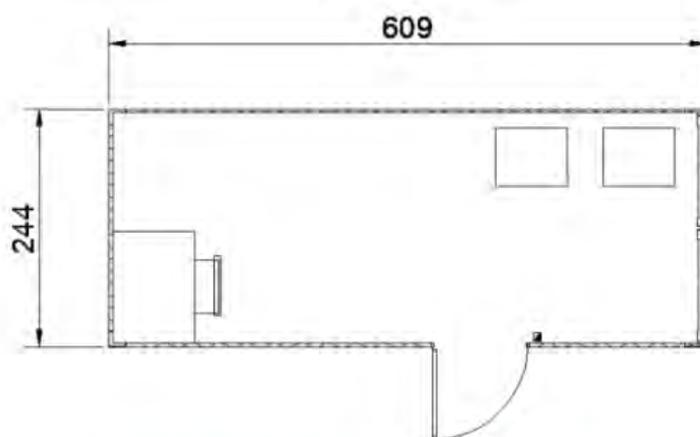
Planta de edificio de control con dimensiones (cm)
